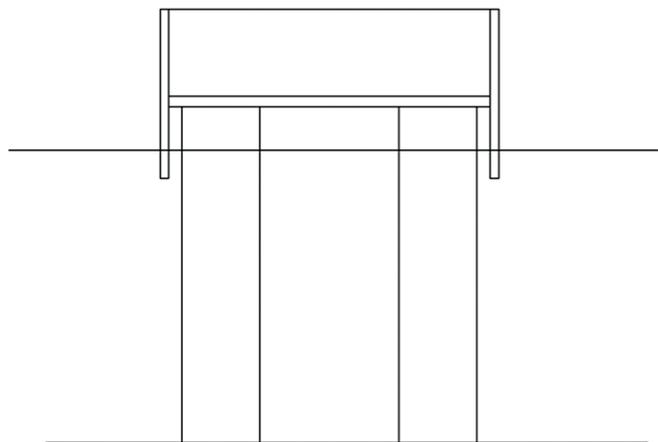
PROJETO EXECUTIVO PARA CONSTRUÇÃO DO BLOCO DE FUNDAÇÃO DO TRECHO DA PONTE DE CONCRETO. PROJETO CONSTRUTIVO DE MARIO VILA VERDE APRESENTA UMA LAJE ADICIONAL
